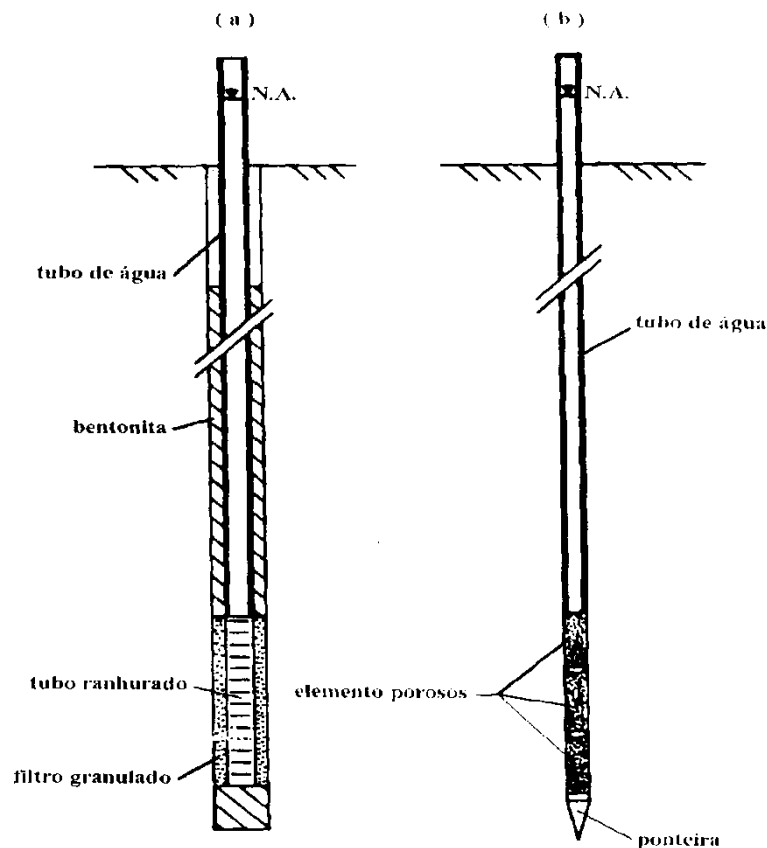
Esquema dos ensaios com piezômetros: (a) escavado e (b) cravado.
